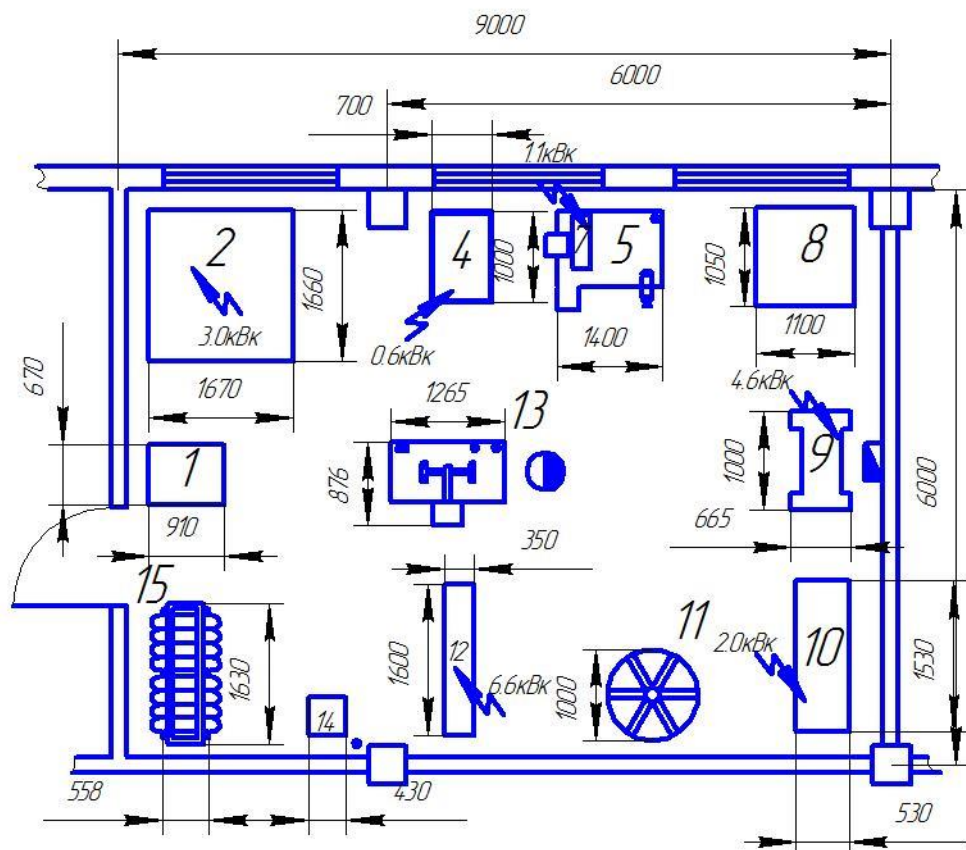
Типовий план шиноремонтної дільниці: 1 – скриня для інструментів; 2 – шиномонтажний верстат; 3 – вентиляція; 4 – верстат для рихтування дисків; 5 – слюсарний верстат; 7 – шліфувальна машина ручна; 8 – мийна ванна; 9 – шліфувальний верстат; 10 – вулканізатор; 11 – оглядовий стенд; 12 – клітка для накачування; 13 – шиномонтажний верстат для шин великих розмірів; 14 – криця для відходів; 15 – стелаж для зберігання коліс.
